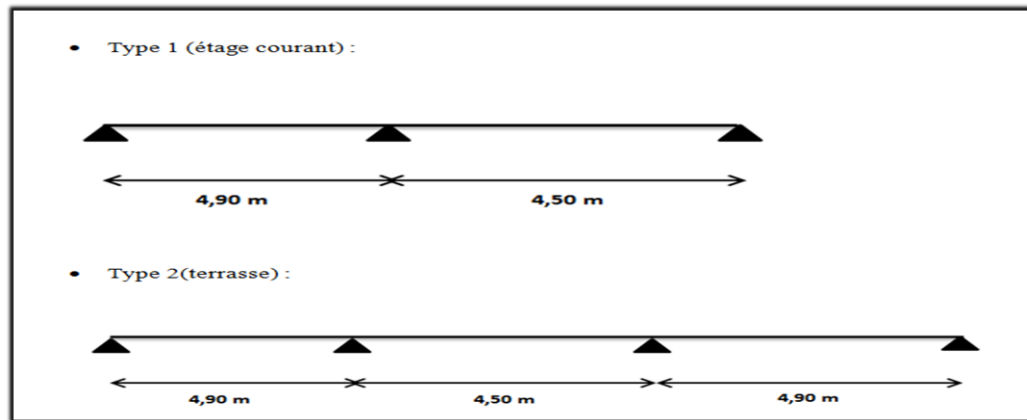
les types des poutrelles des blocs B1.1 ; B2.1
